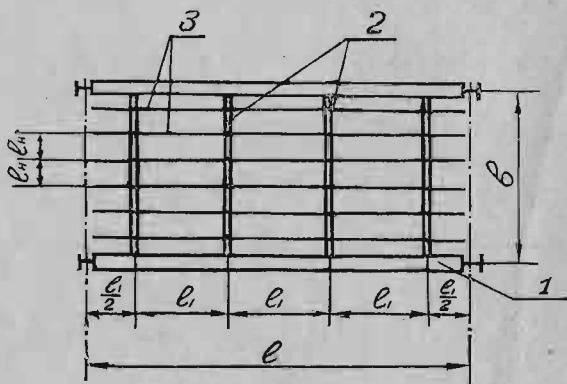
1—главная балка, 2—вспомогательная балка, 3—прогоны.
